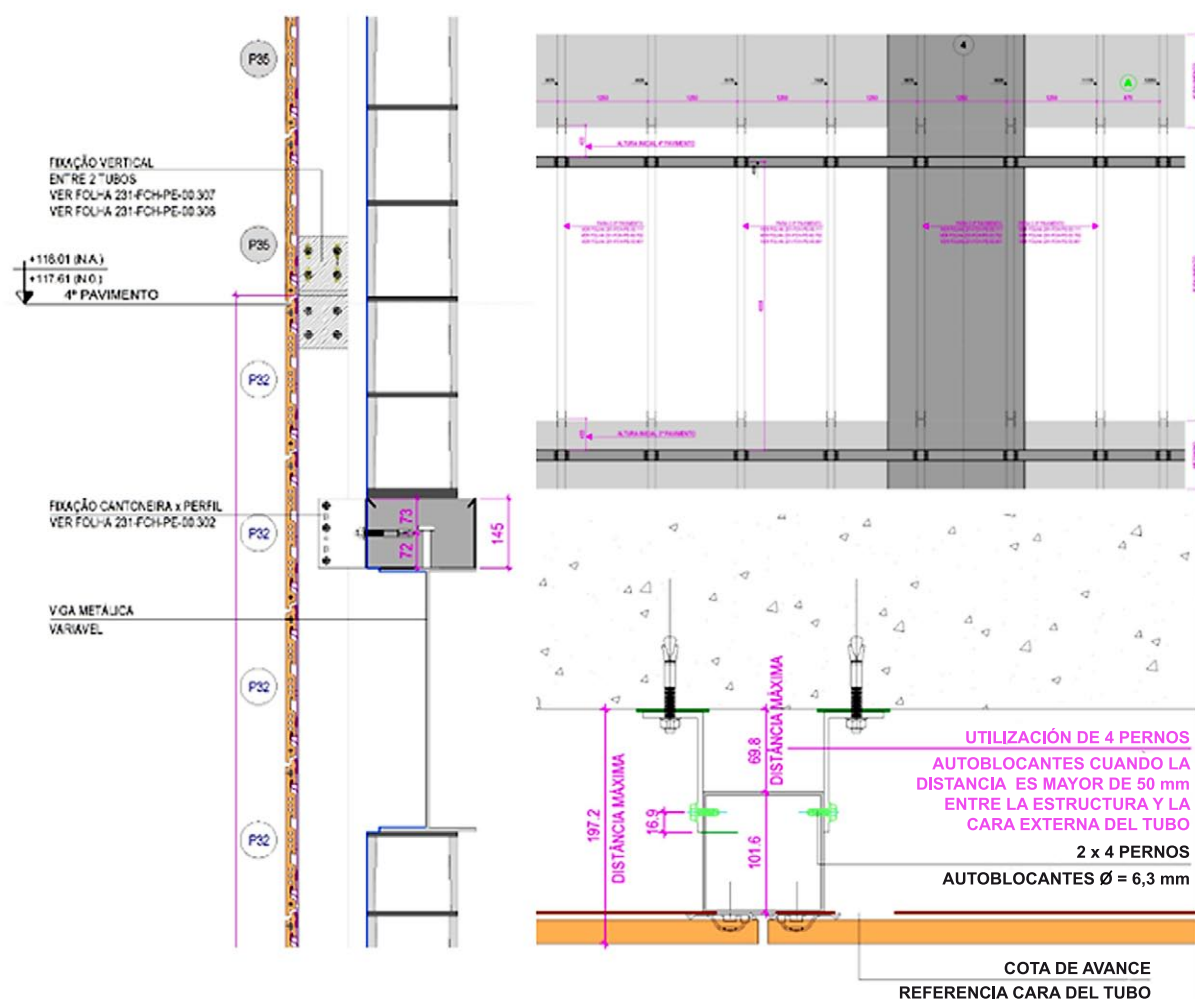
Detalle del sistema ventilado: perfil del tubo conectado a la estructura por ángulos y pernos de acero inoxidable.
